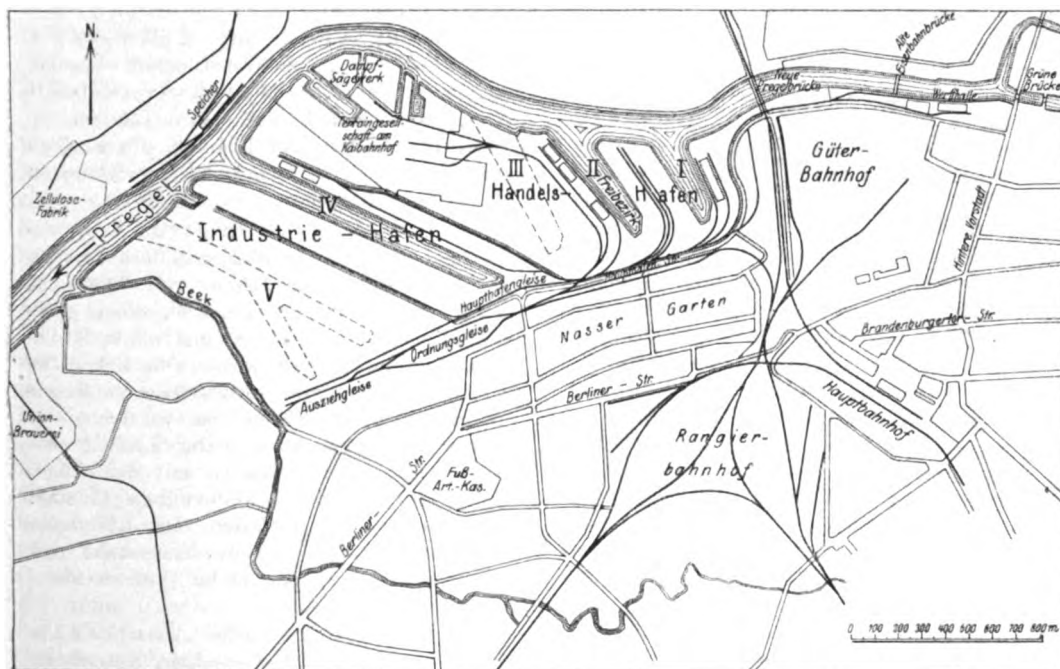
Lageplan der Hafenanlagen in Königsberg (Pr.).
